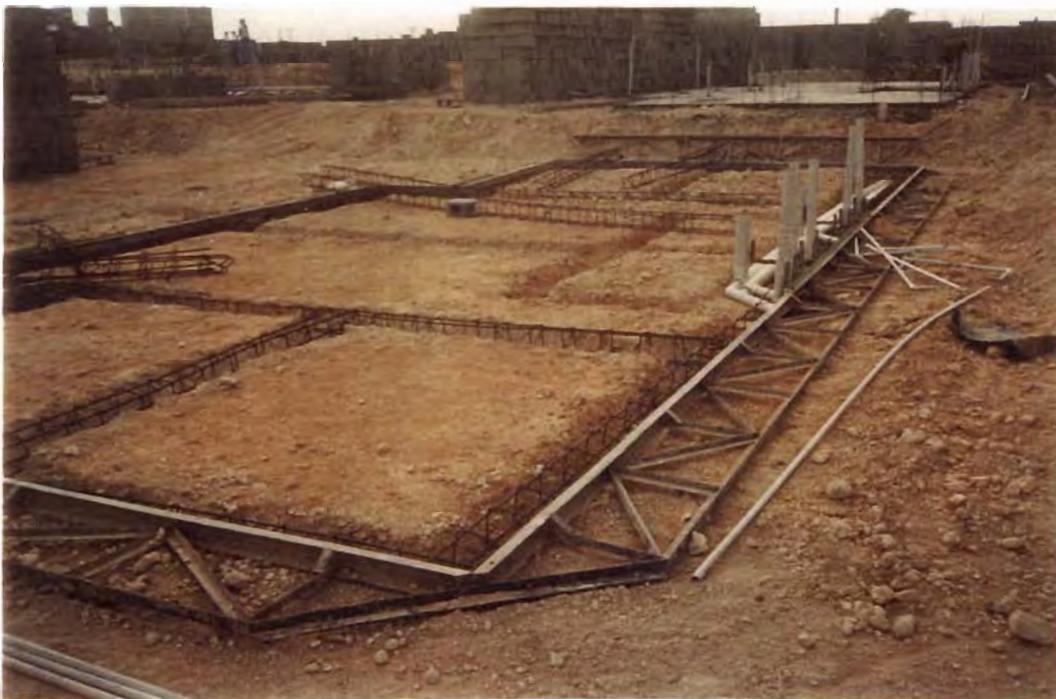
Losa de cimentación. Obsérvense los moldes armados sobre el terreno, las vigas excavadas en los sitios donde van a quedar los muros y los hierros de refuerzo de dichas vigas, los cuales son hechos por la comunidad.
